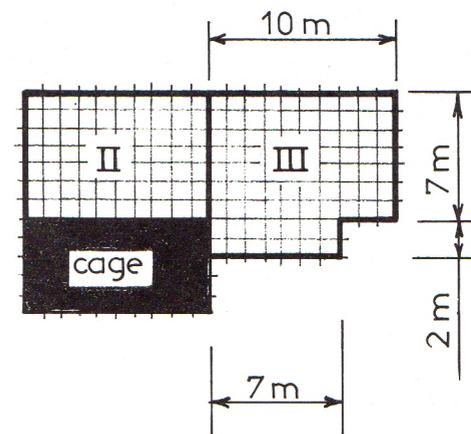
EXEMPLE DE COMPOSITION D'UN PLAN D'ETAGE COURANT SUR LA MAILLE DE 90x90
